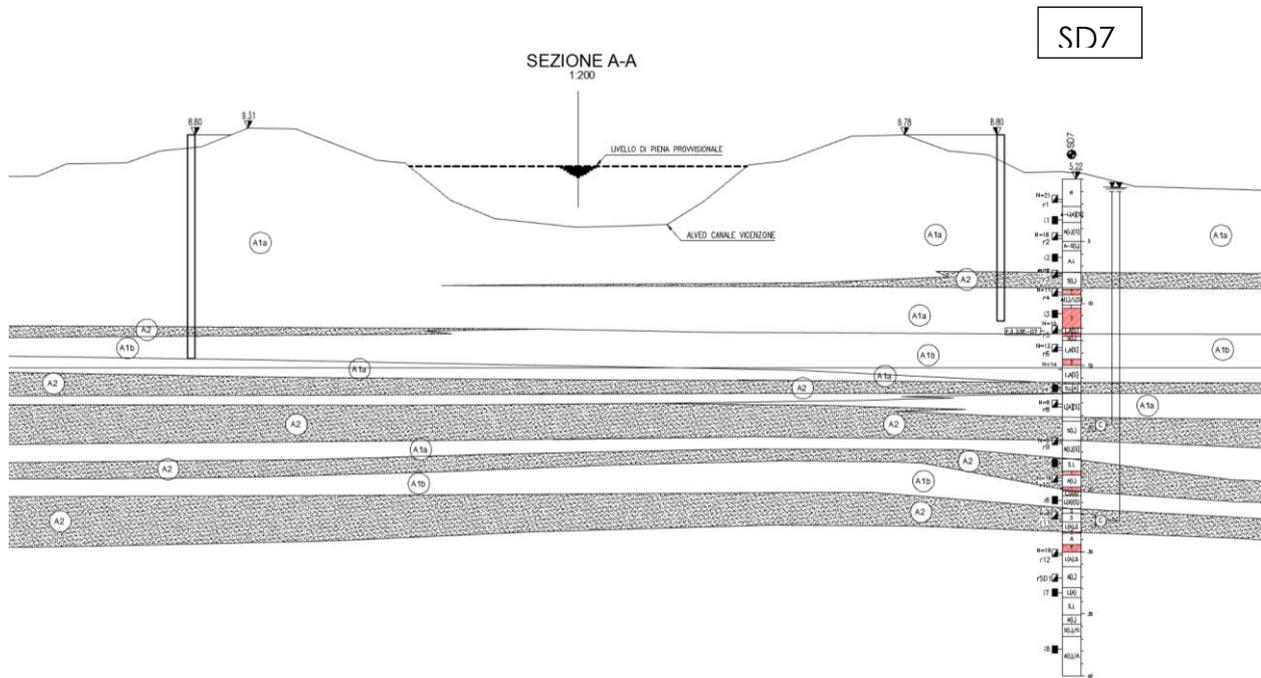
Ponte Canale Vigonza - Sezione geotecnica A-A
